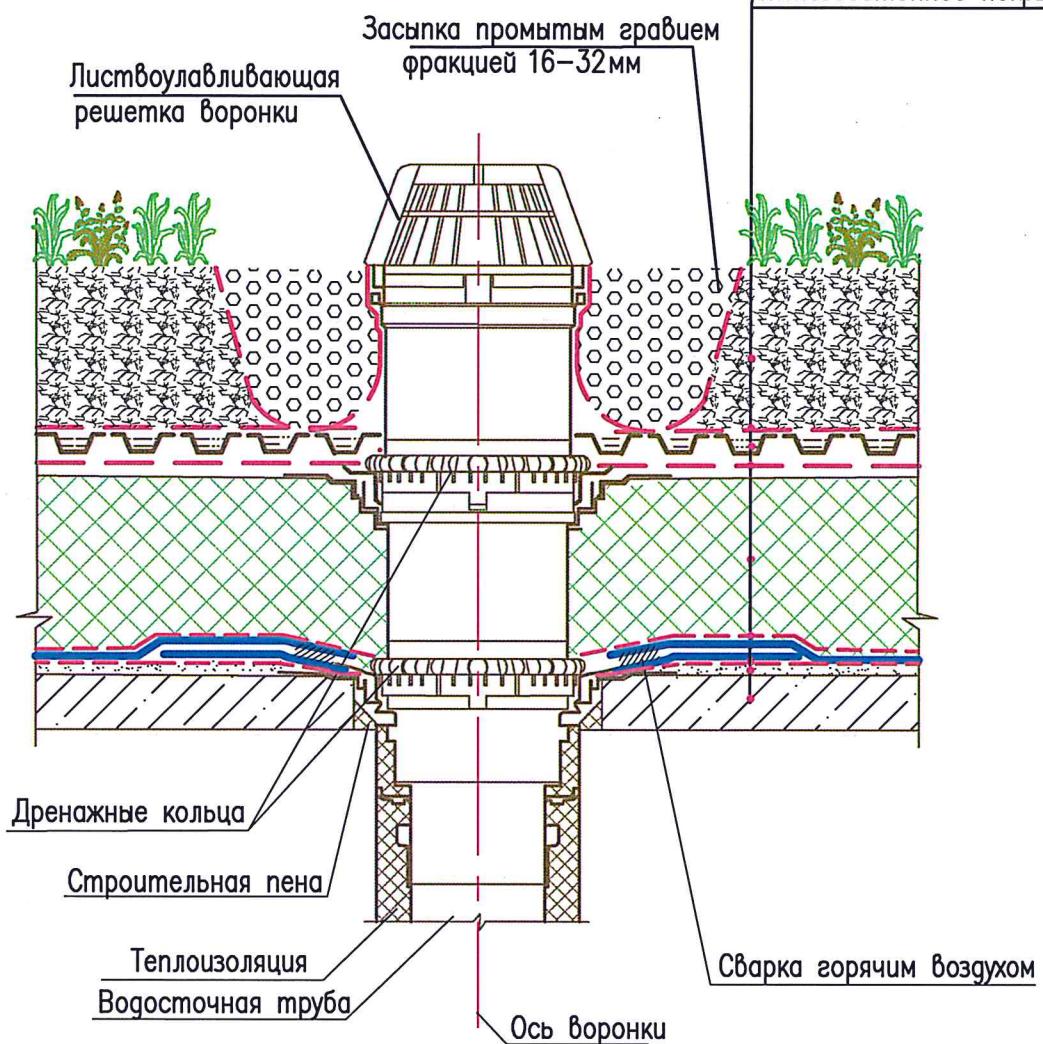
Воронка на инверсионном покрытии с почвенным слоем по железобетонному основанию
